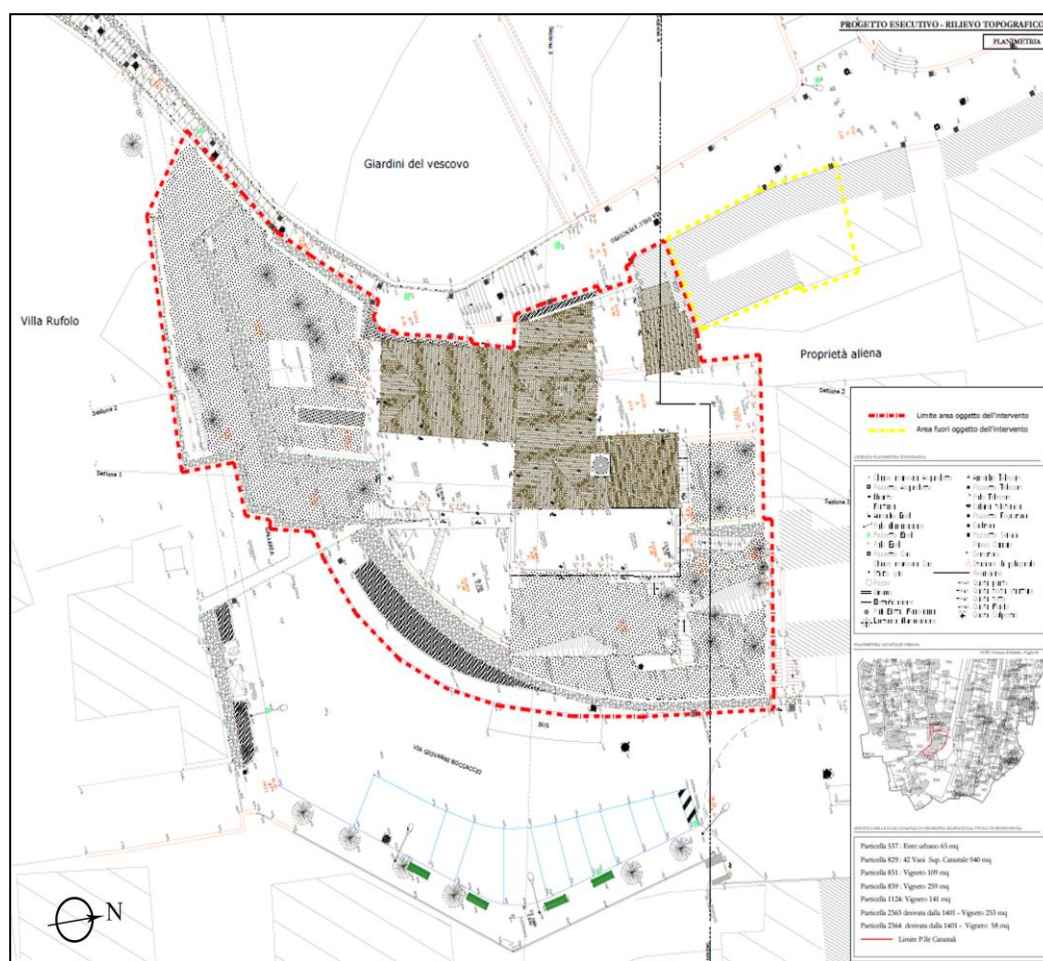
TEO.01 Rilievo topografico- planimetria con perimetrazione area oggetto dell'intervento (rosso) e area esclusa dall'intervento (giallo)
